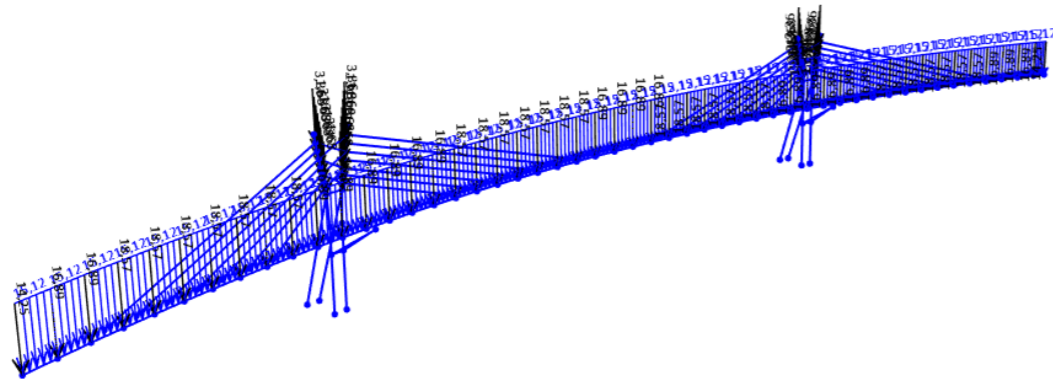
Cargas muertas aplicadas sobre el modelo de la estructura. Fuente: Elaboración Propia (SAP2000)
